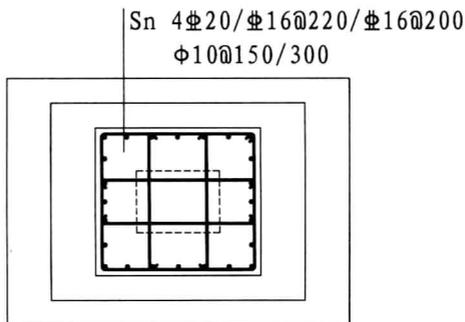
高杯口独立基础杯壁配筋示意
